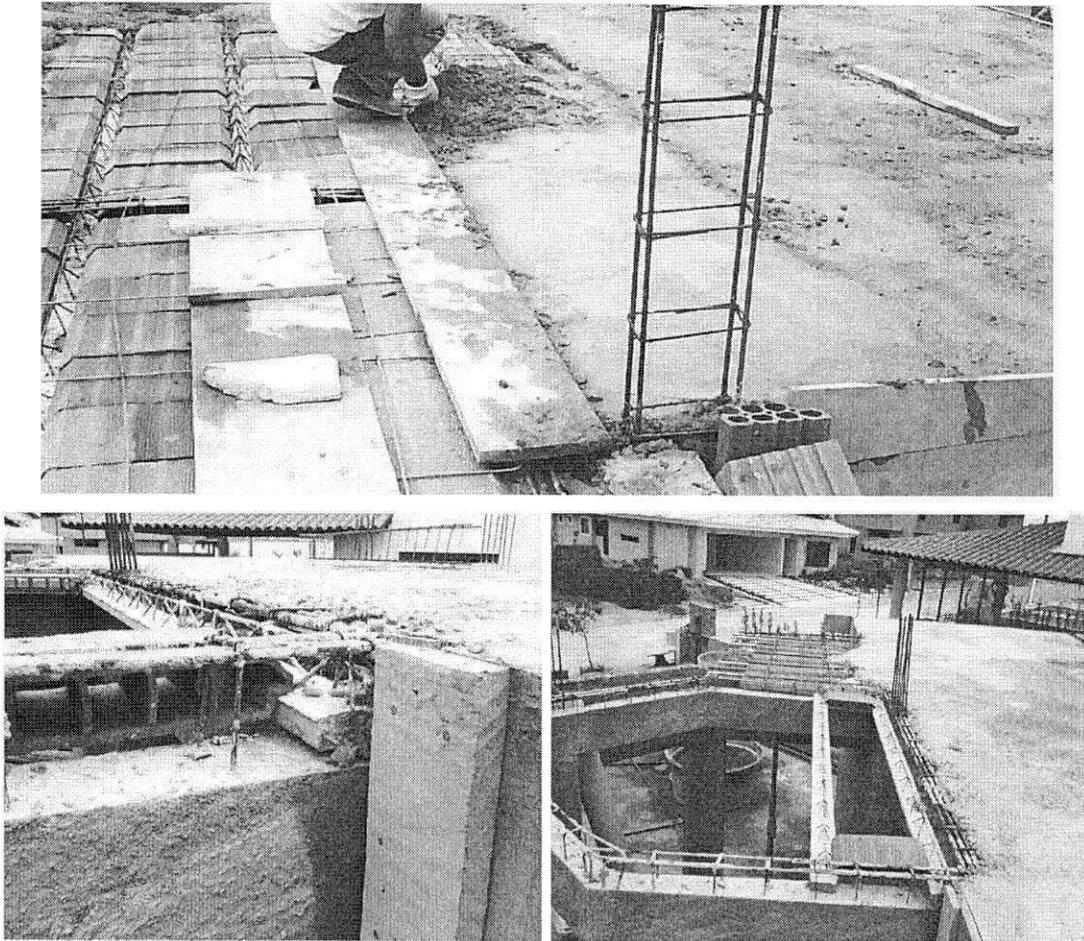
a 78 – Concretagem da laje, vista da ferragem negativa e estribos de encaixe das vigotas
